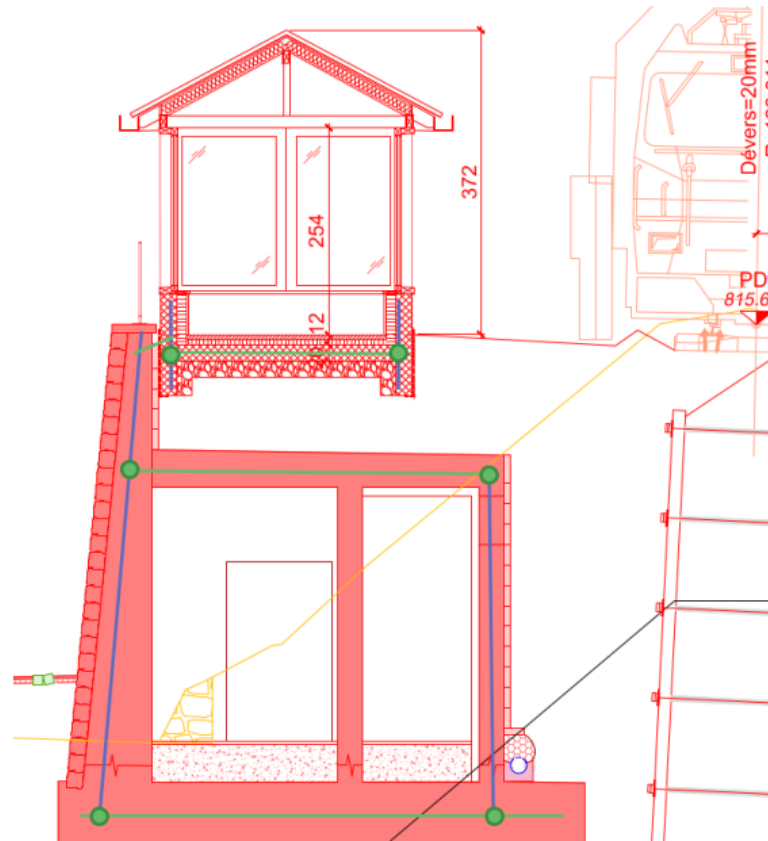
Disposition en coupe des barres collectrices (vert : horizontal, bleu : vertical)).
